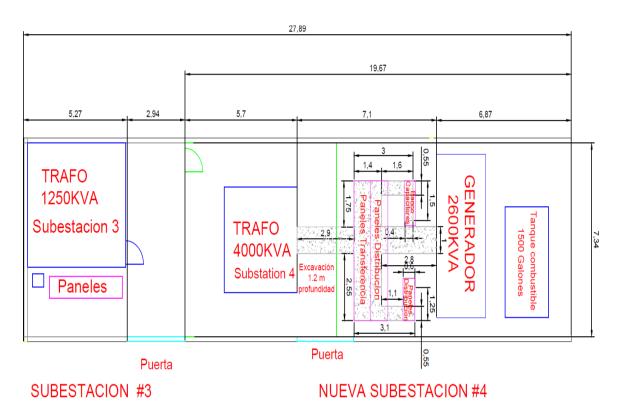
Plano Subestación eléctrica #4 Novem, Honduras (Fuente: Elaboración propia, 2021)
